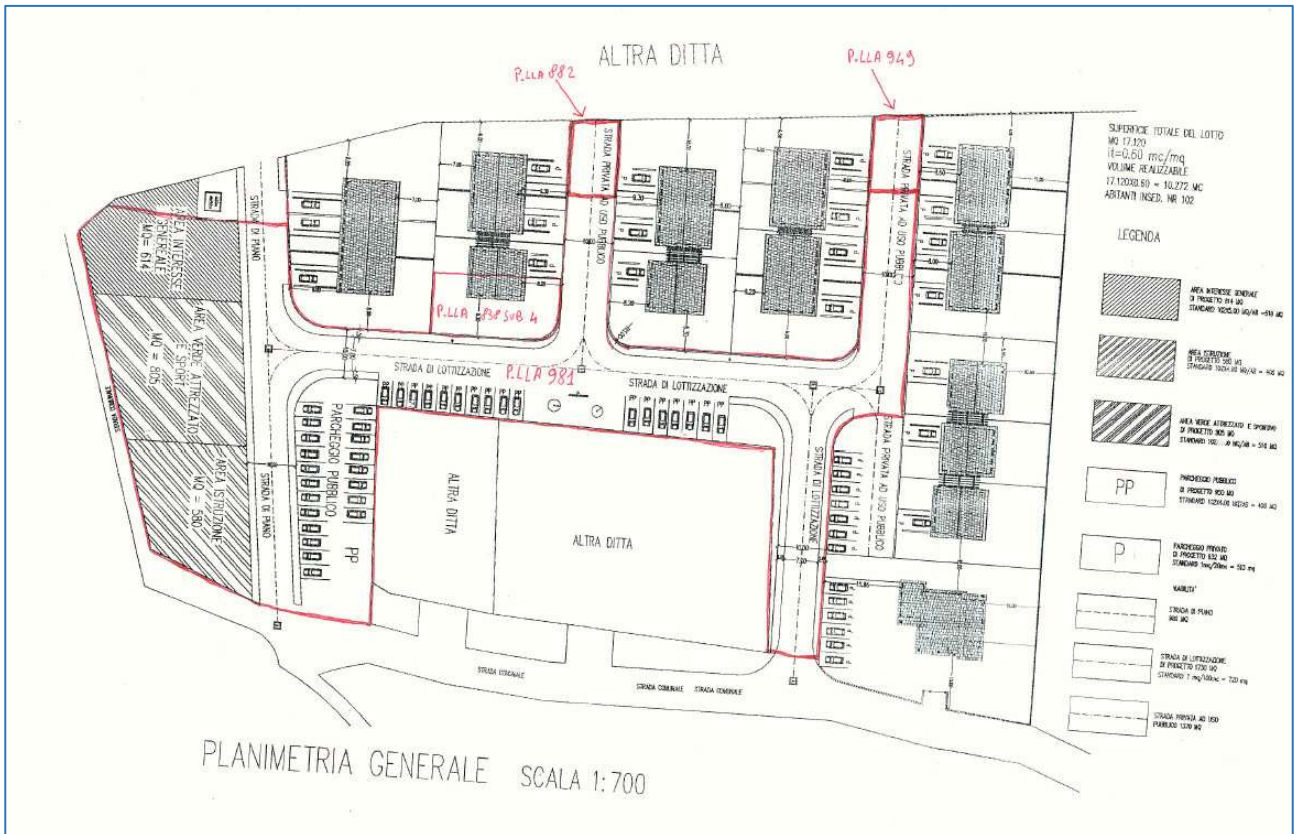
Planimetria lottizzazione - da CTU arch. De Rose
